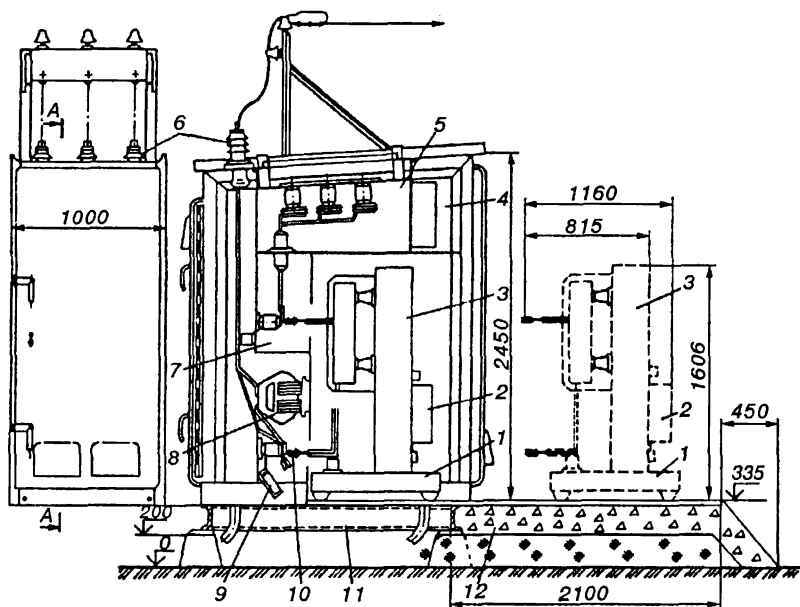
Конструкция шкафа КРУН-10 фидера воздушной линии
